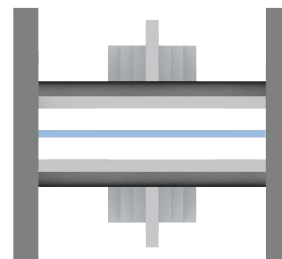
Vorentwurf II, Grundriss Stütze mit zusammengefalteten Sekundärträger
